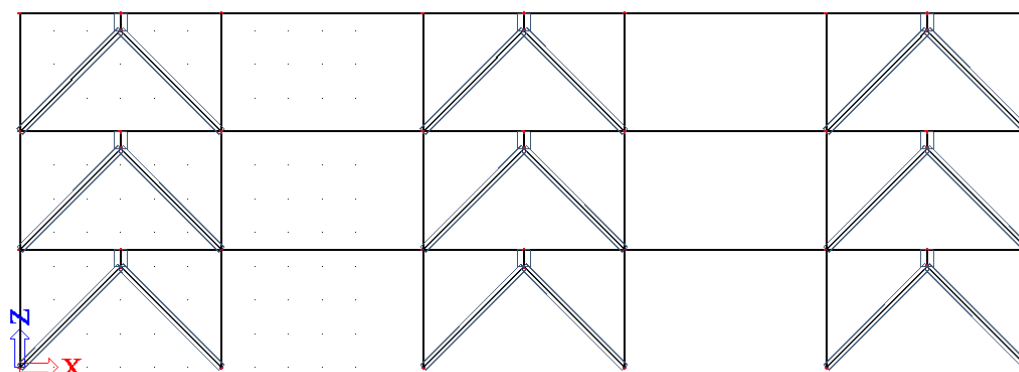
Geometria excentrického stužidla – 3-podlažný rám – varianta 1
